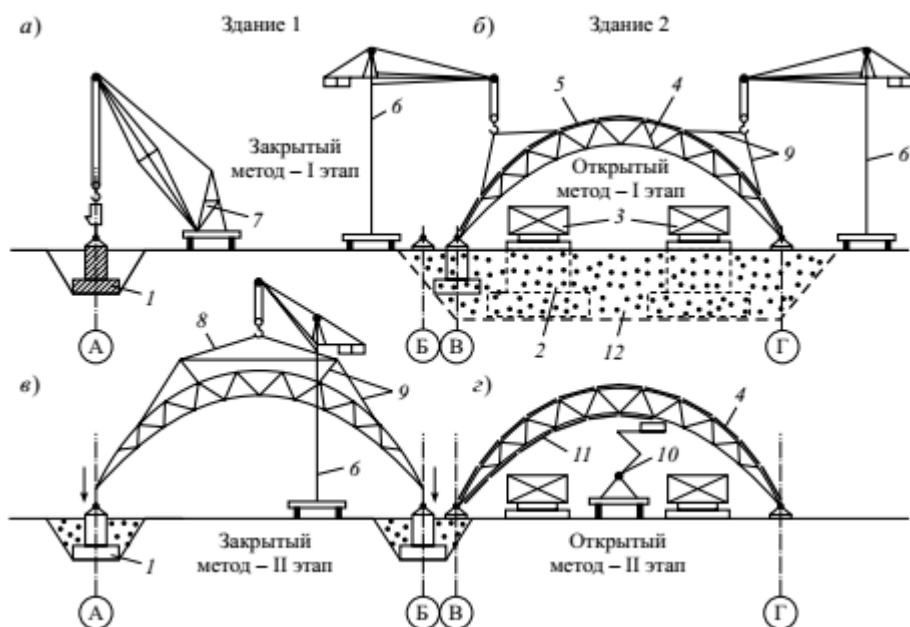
Технологічна схема комбінованого методу монтажу багатопрілітної будівлі: а, б, в, г - етапи зведення будівлі (закритий метод для будівлі № 1 і відкритий метод для будівлі № 2); 1 - фундаменти під каркас; 2 - фундаменти під устаткування; 3 - технологічне устаткування; 4 - змонтовані конструкції покриття; 5 - плити покриття; 6 - крани веж; 7 - автокран; 8 – монтажна траверси; 9 - строп; 10 - автогідропідійомники для облаштування підвісної стелі; 11 – підвісна стеля; 12 - зворотна засипка котлованів
